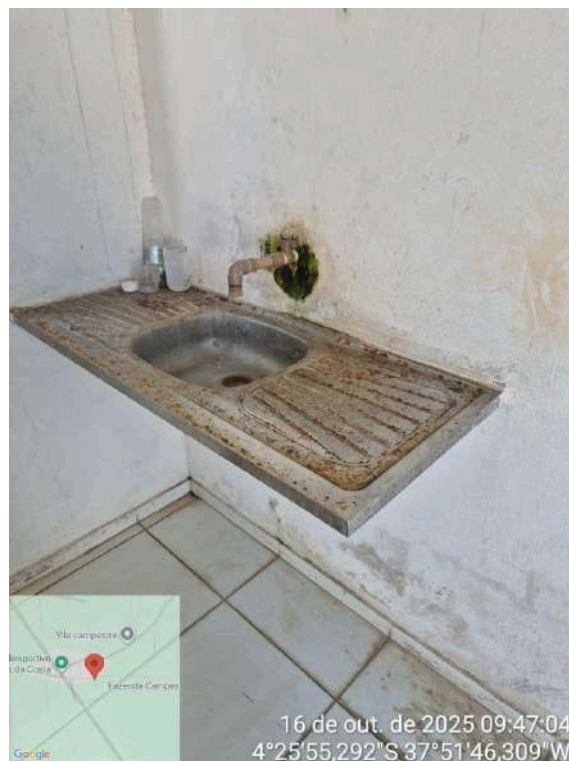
Sala de Apoio e Banheiro: Pia com oxidação e vazamento na parede indicado pela presença de lodo.
